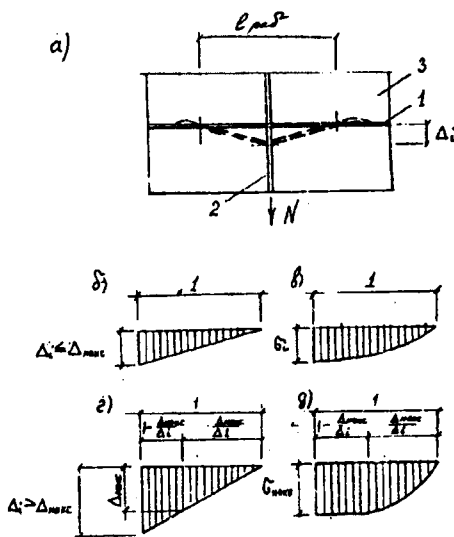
Эпюры перемещений поперечного стержня и напряжений в бетоне под стержнем а — схема перемещений; б, г — эпюры перемещений на единичной длине; в, д — эпюры напряжений на единичной длине; 1 — поперечный стержень; 2 — продольный стержень; 3 — ячеистый бетон
